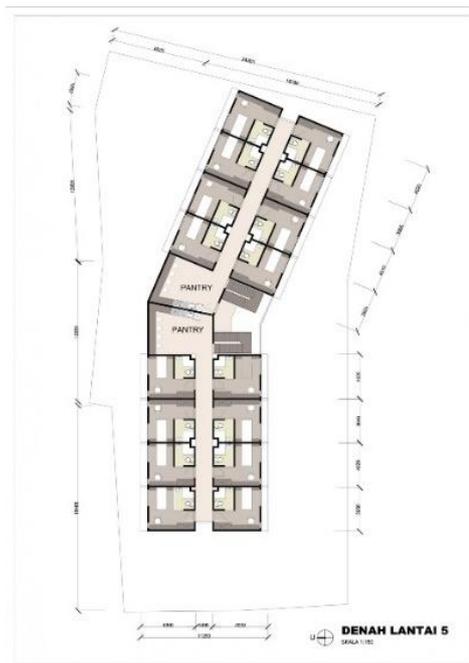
Denah final Kos KH. Mas Mansyur
